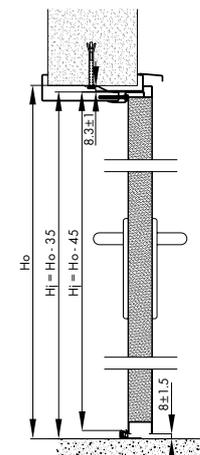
Montage einflügeliger Türen mit Umfassungszarge an der Mauer - Vertikalschnitt.
